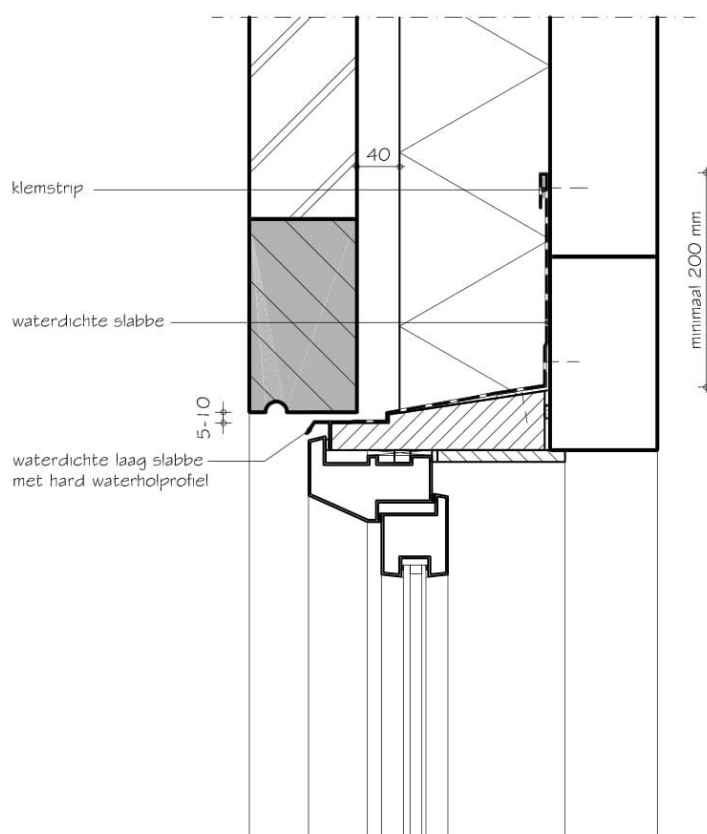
Kozijnaansluiting bovendorpel met latei
